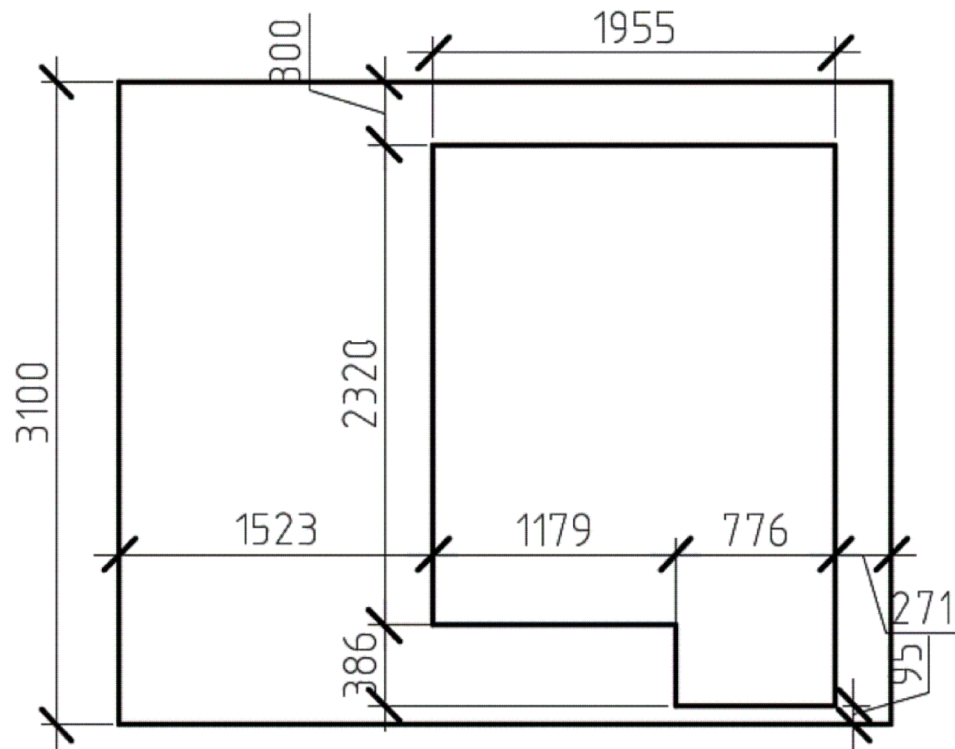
Схематический вид наружной стены в осях «В/1-2» (комнаты 2) до перепланировки
